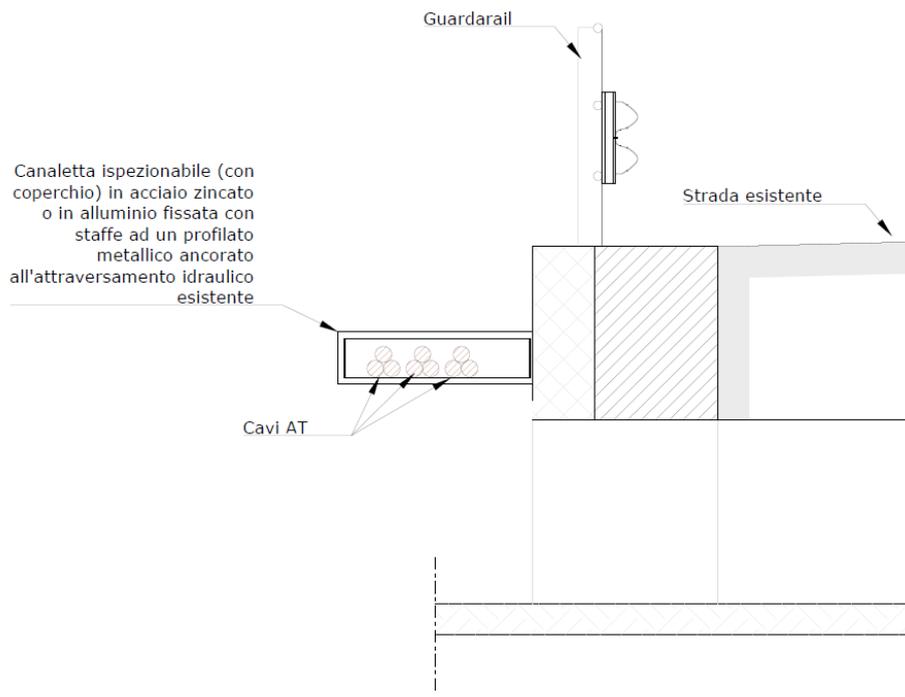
Sezione trasversale cavidotto MT in fiancheggiamento al ponte o cavalcavia.
